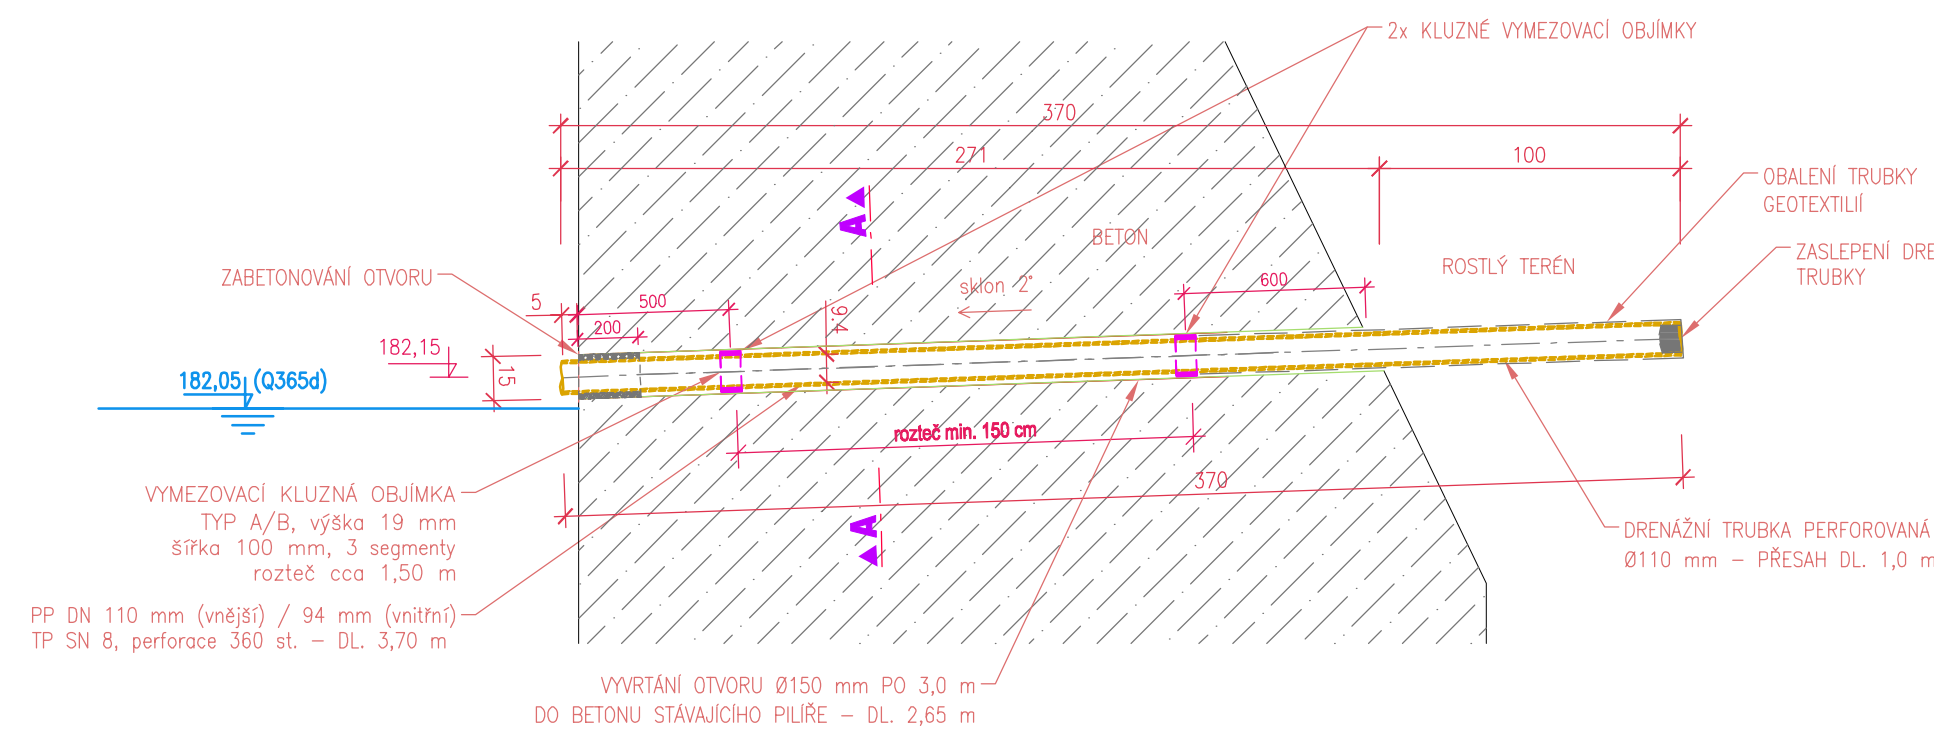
DETAIL DRENÁŽE - ŘEZ STĚNOU PILÍŘE
